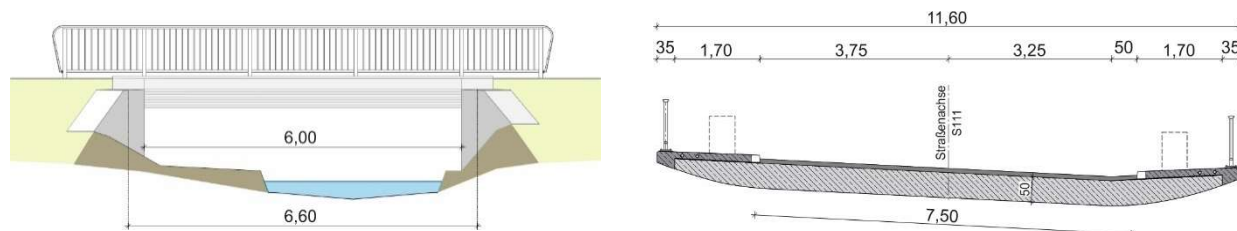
Längsansicht und Querschnitt des Bauwerks
